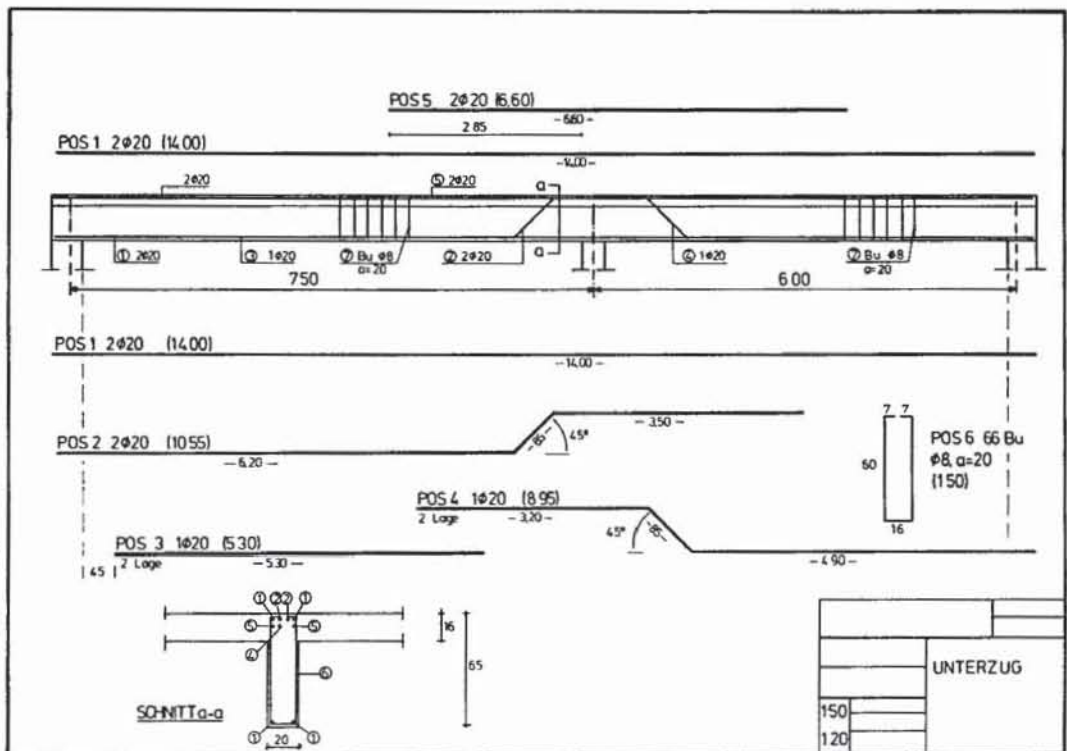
Bewehrungsplan mit maßstäblichem Bewehrungsauszug für einen Zweifeldträger
